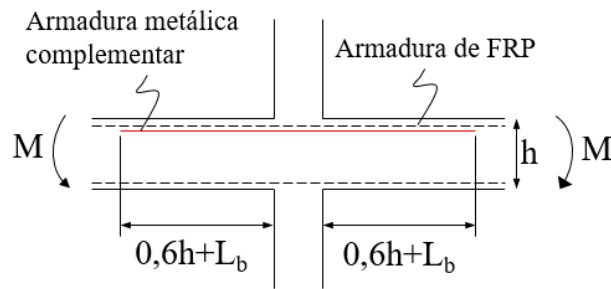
Disposição de armadura metálica complementar em apoio intermediário de viga contínua.
